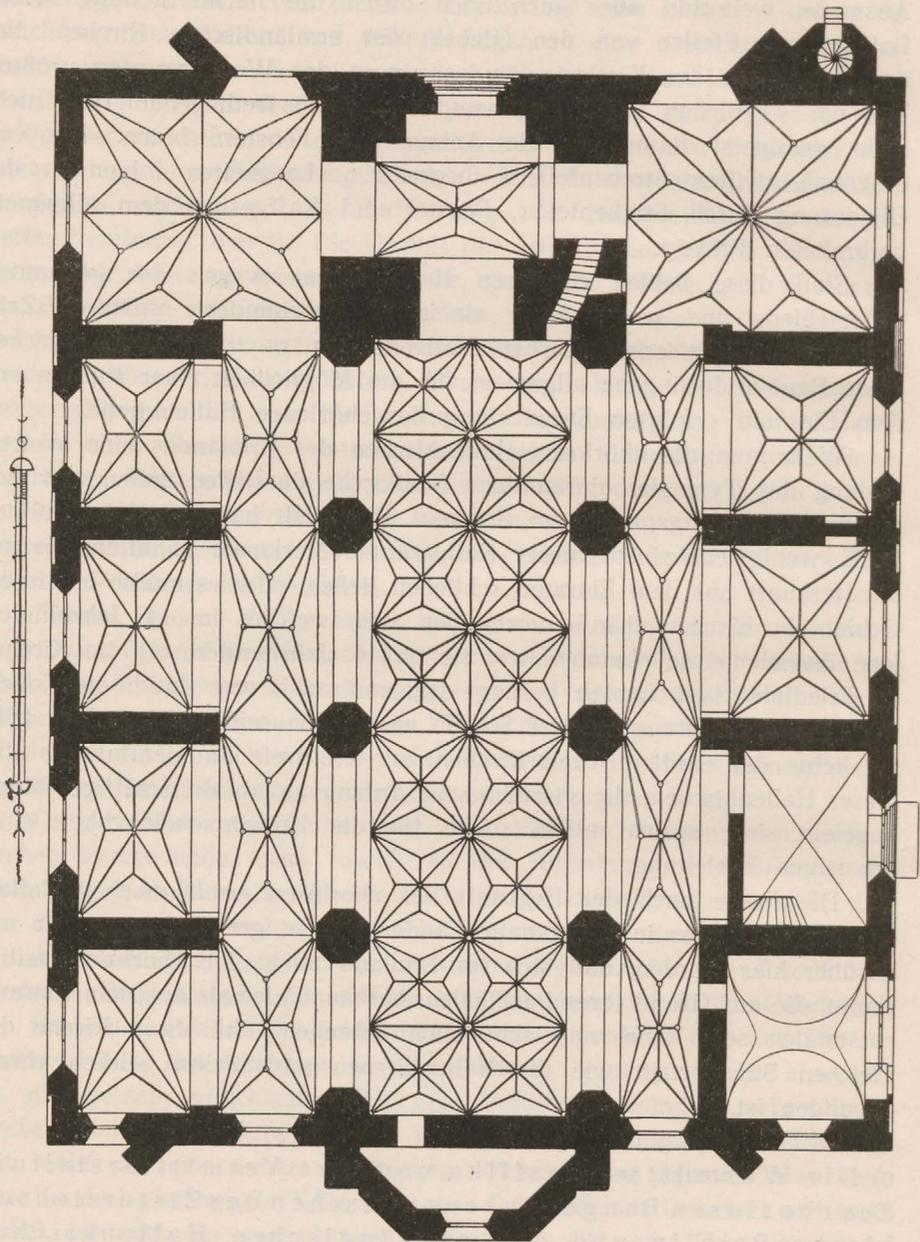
Pfarrkirche zu Wormditt, Grundriß.
